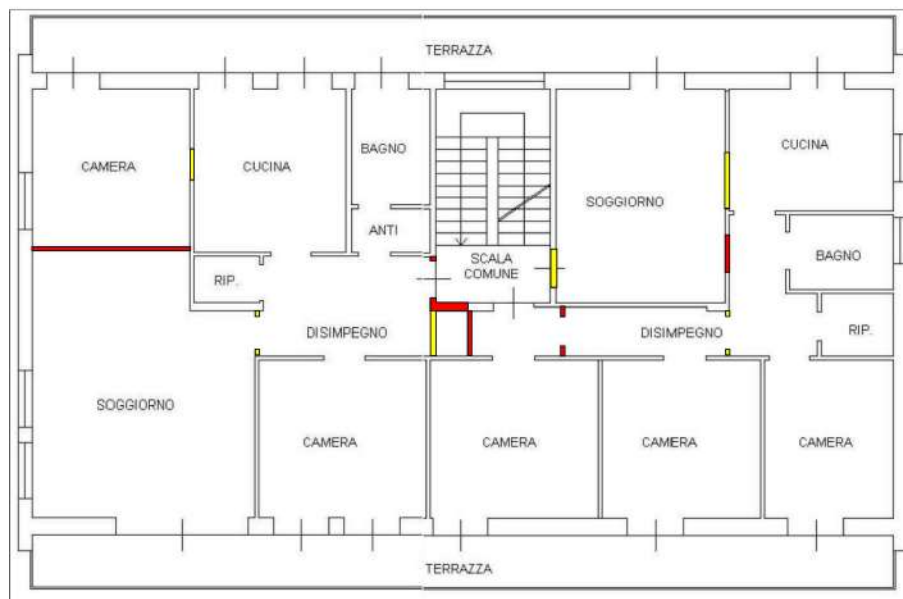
Sovrapposizione tra lo stato del progetto approvato e la planimetria catastale
